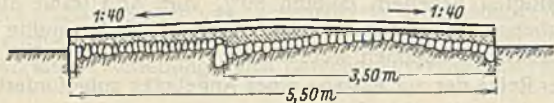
Querschnitt durch die neue Fahrbahn (Verfahren II).
